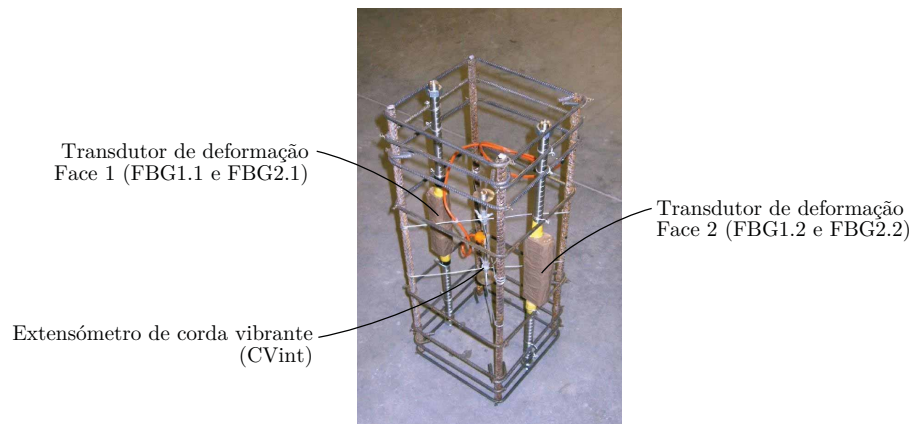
Vista geral da armadura e instrumentação interna adoptada no prisma de betão.
